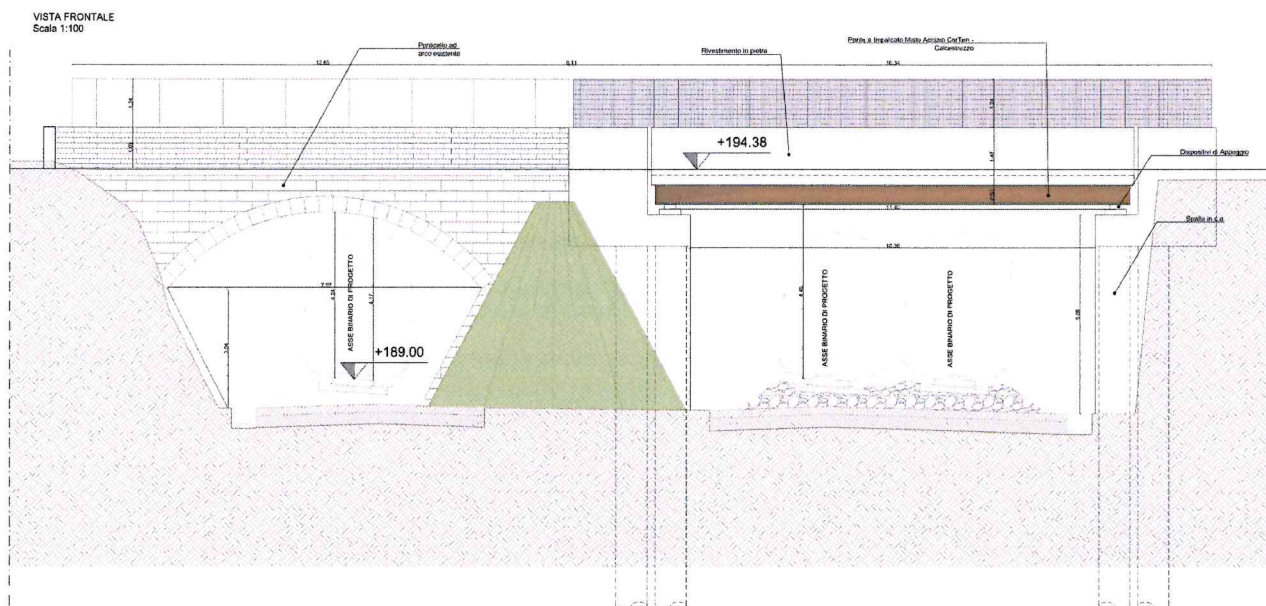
Sovrappasso in muratura km 21+900 – Progetto – Prospetto
